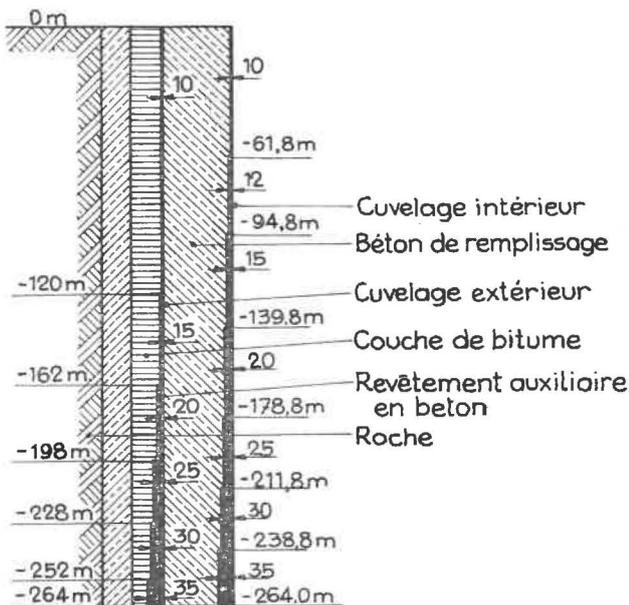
Coupe à travers le revêtement des puits de Wulfen.
